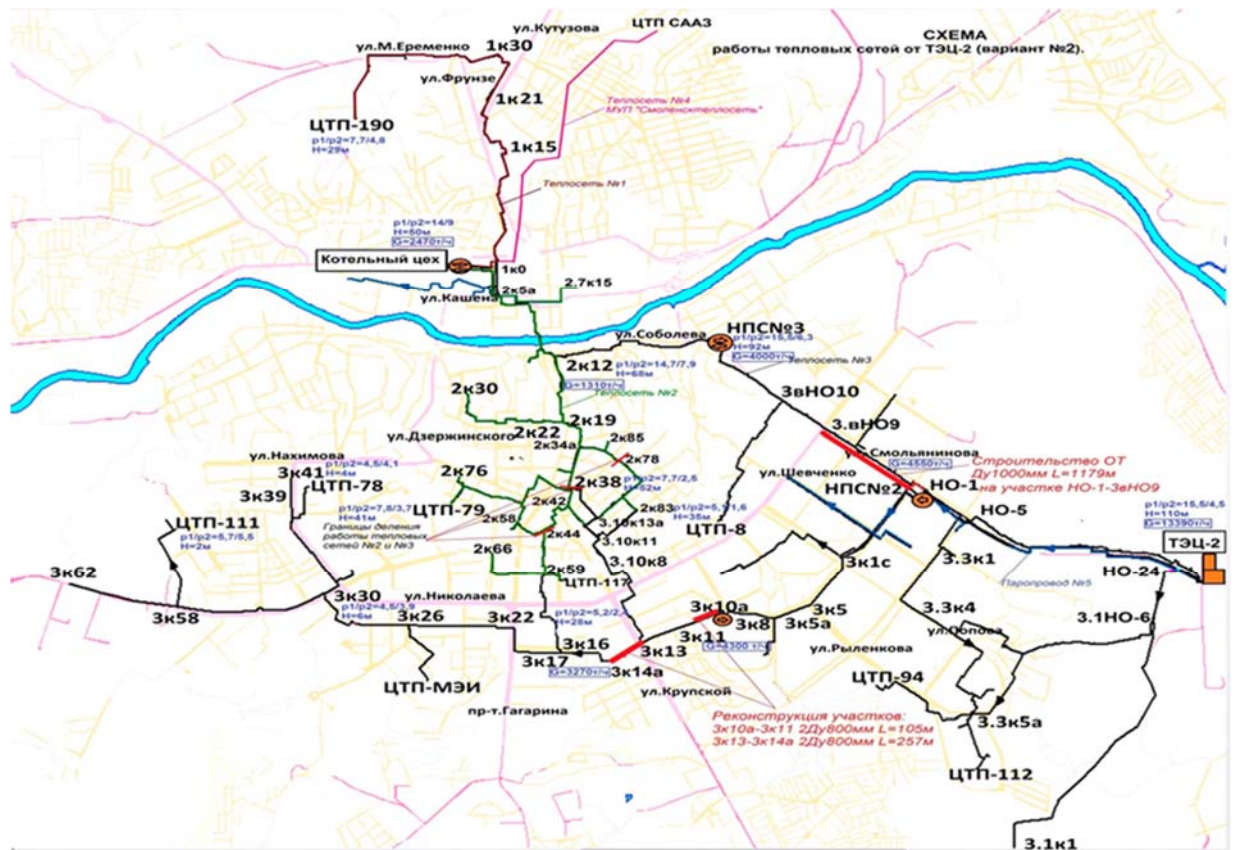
Схема теплоснабжения после перевода тепловой нагрузки с котельного цеха на Смоленскую ТЭЦ-2
